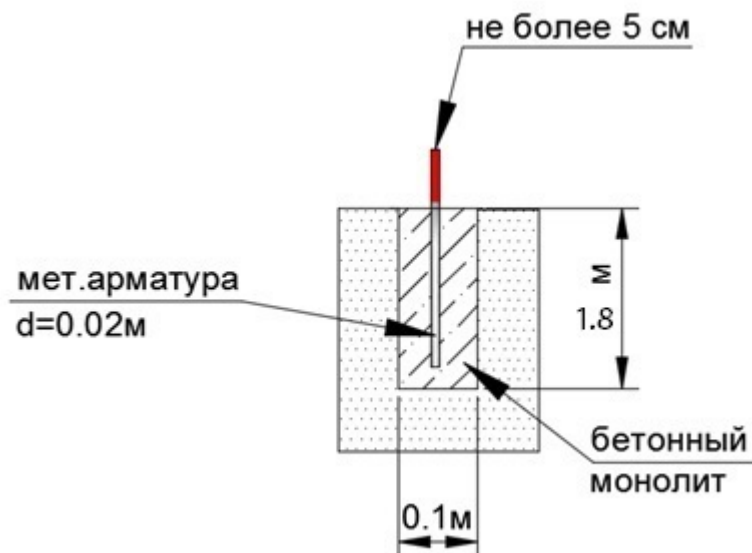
Схемы конструкции репера (поперечное сечение).
